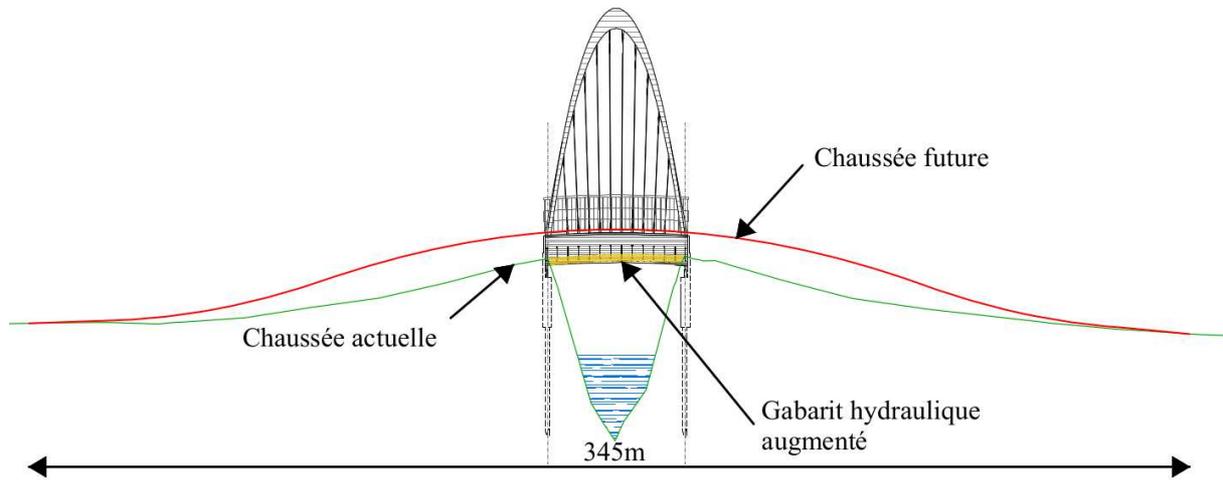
Adaptation du profil en long du pont sur la Thielle avec rehaussement (+ 109 cm) pour gabarit hydraulique (échelle déformée)
